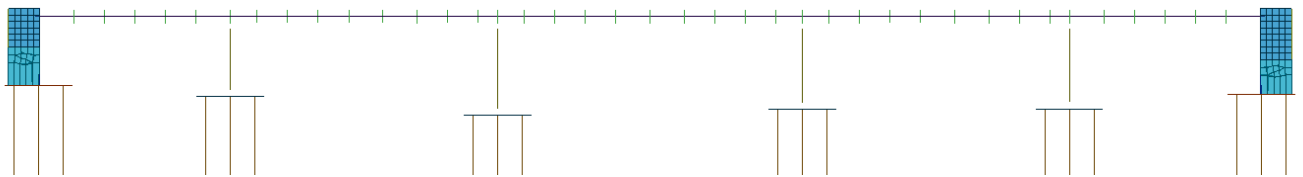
Modellazione tridimensionale Elementi finiti – prospetto longitudinale
